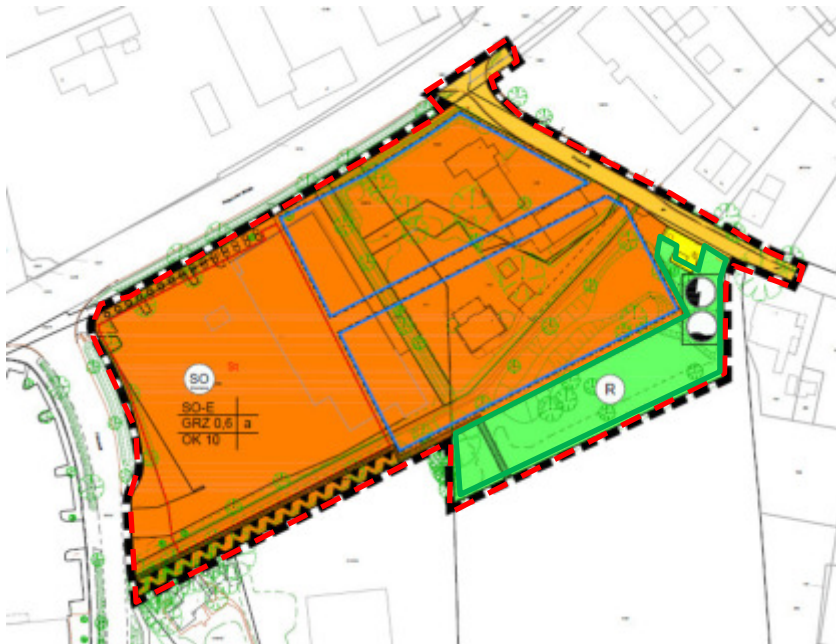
Bebauungsplan zur 2. Änderung (DN Stadtplanung, Stand Juni 2021)
